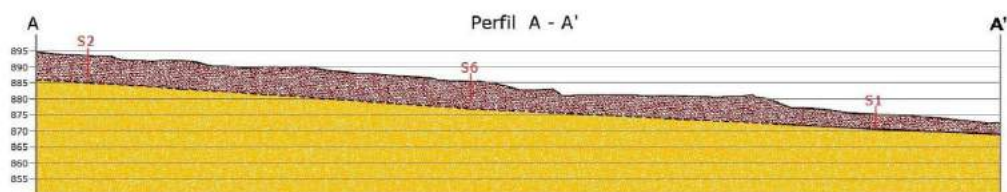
Perfil do terreno (direção do perfil: SW – NE (ver anexo Planta Geológica)).
